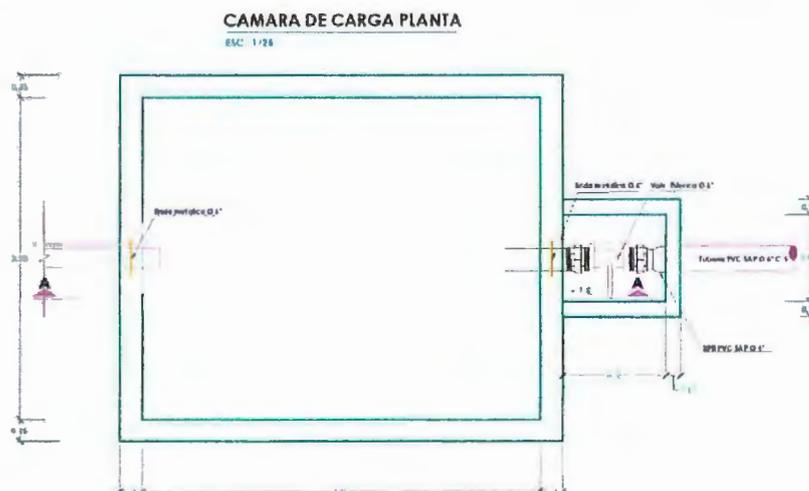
Sección Típica en Planta de la Cámara de Carga
